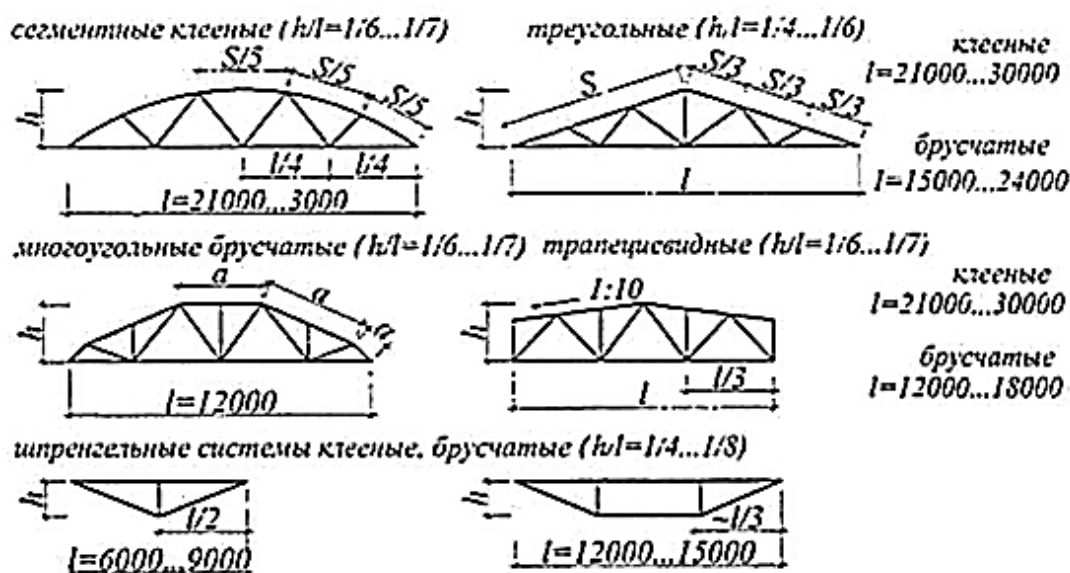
Примеры типовых деревянных стропильных ферм
